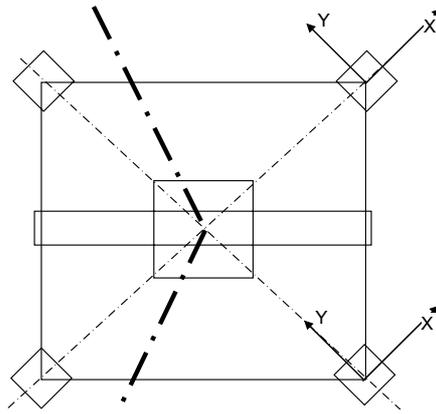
Система отсчета векторов нагрузок на фундаменты
